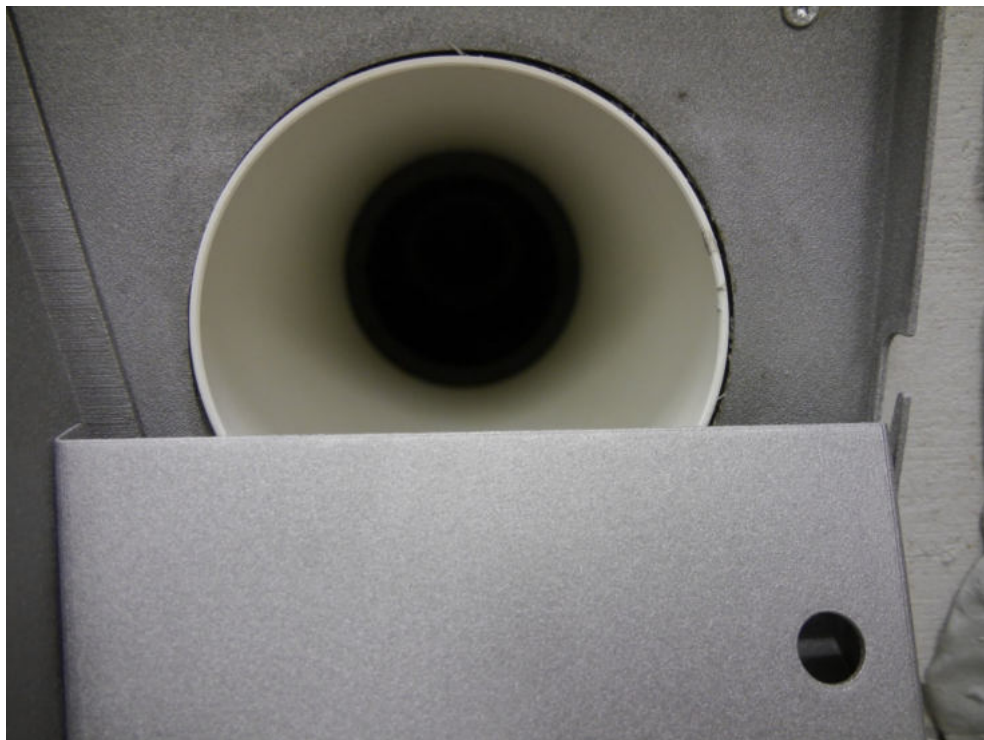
Lüftungsrohr AUL, Variante mit Schalldämmeinlage
